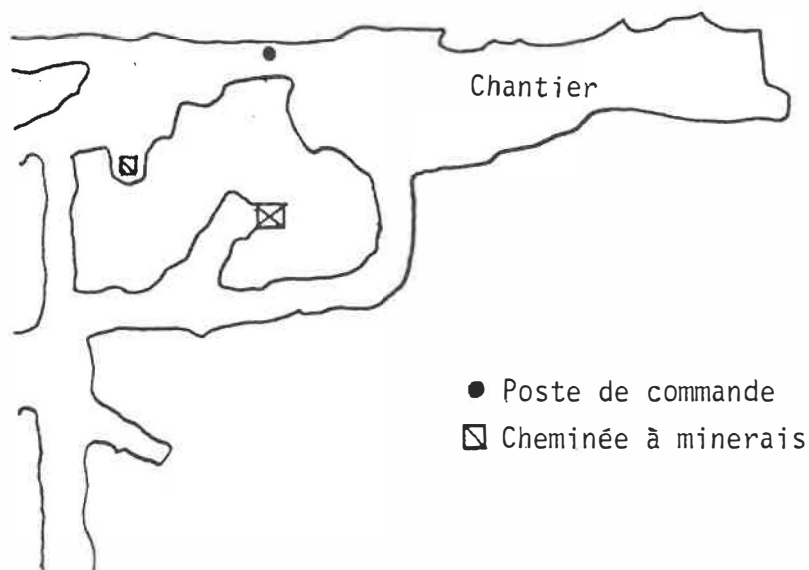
Plan du chantier d'essai, Mine Lyon Lake
